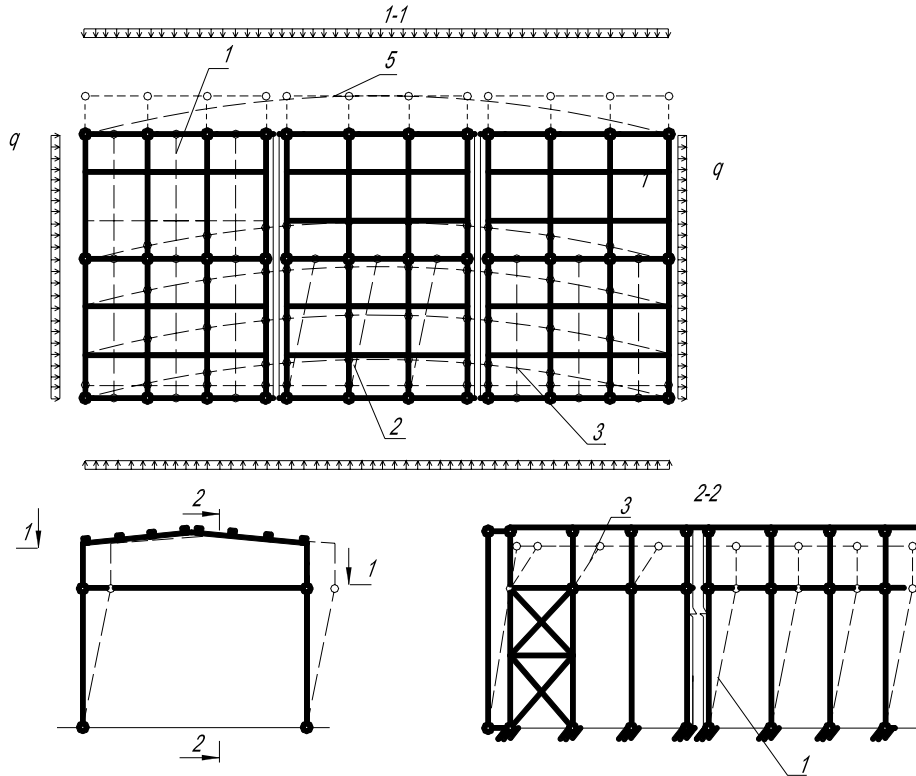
Кинематическая схема каркаса здания без связей с шарнирно опертыми колоннами
